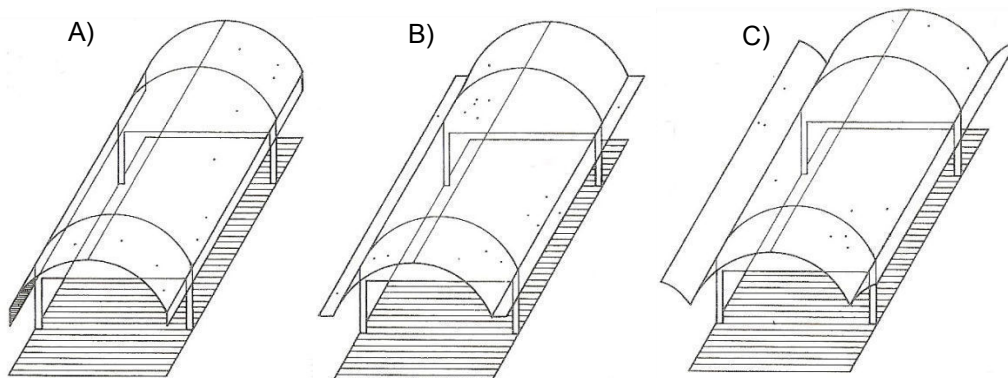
A) Viga de borde vertical; B) Viga de borde horizontal; C) Membrana adyacente. (11)
